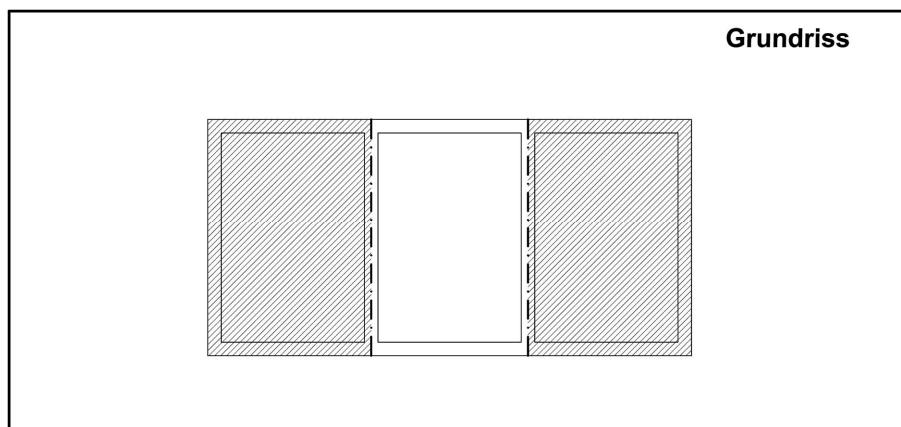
Grundrissansicht: unabhängige Baueinheit
